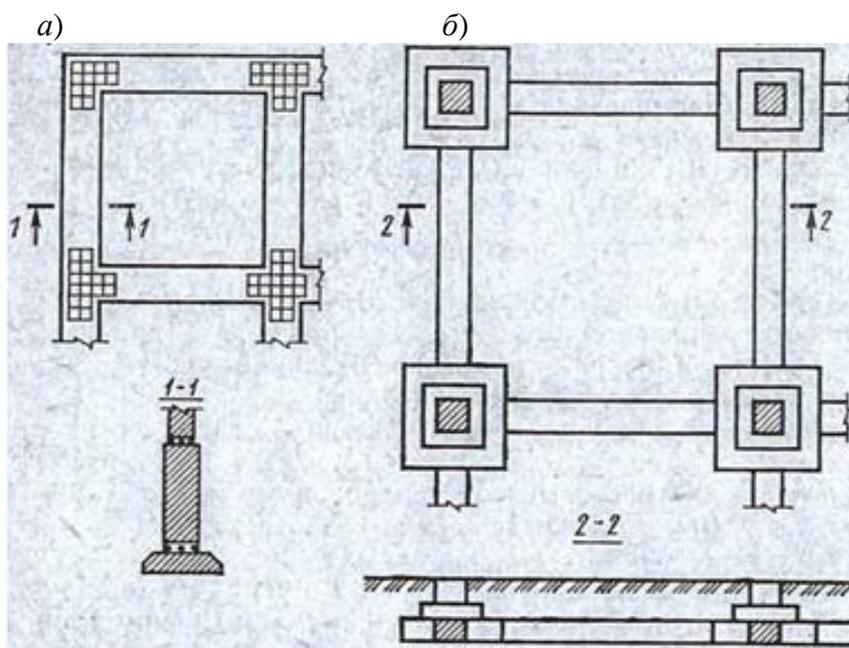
Рекомендуемые схемы фундаментов в сейсмических районах
